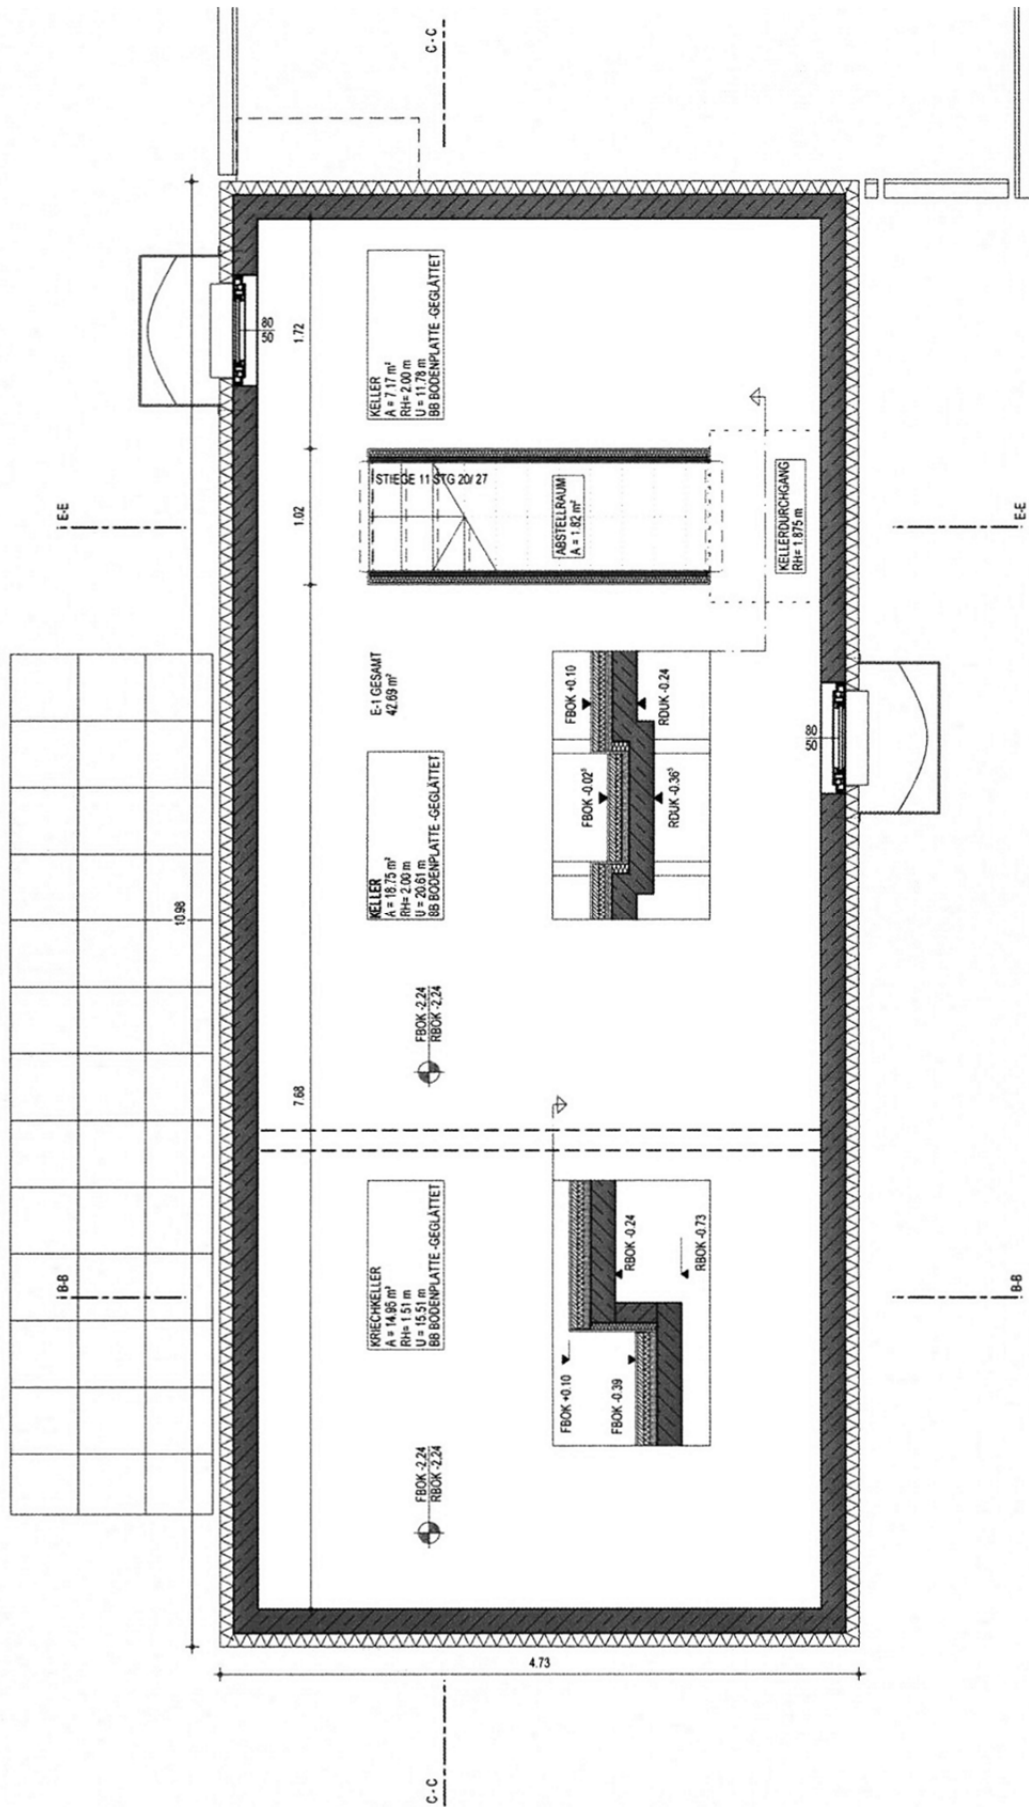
Grundriss Keller _ Typ D mit Keller
